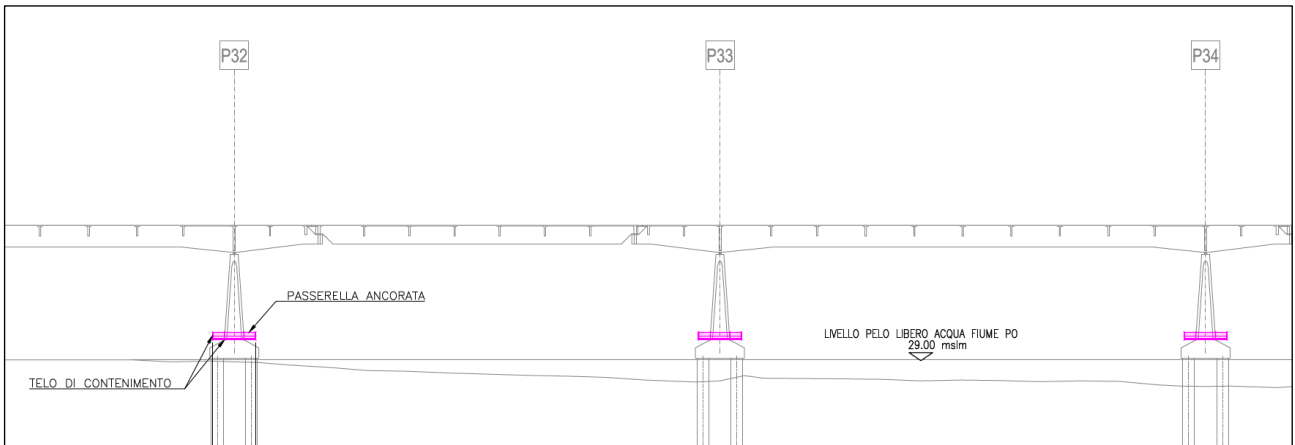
Passerelle ancorate alla base delle pile, con telo impermeabile di contenimento per i tratti in alveo
